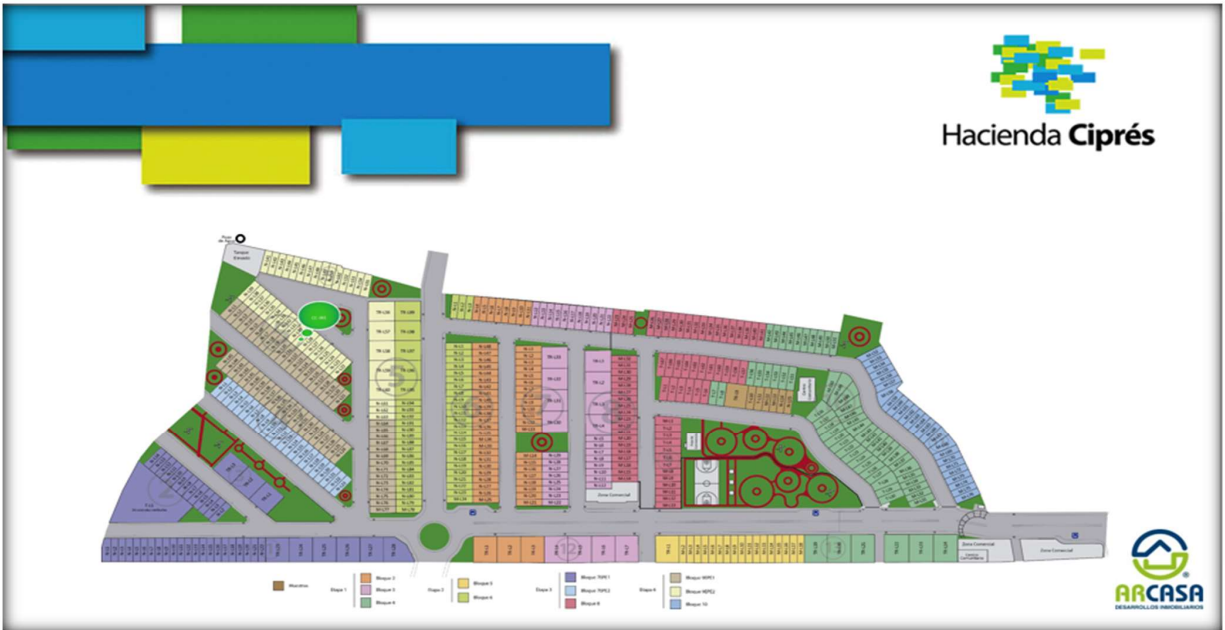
Plano de Conjunto Fraccionamiento Hacienda Ciprés
